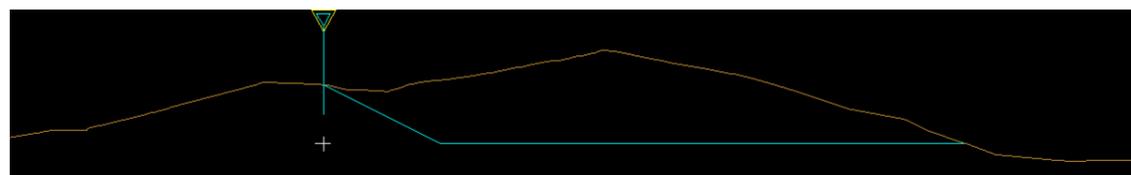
Representación transversal de la excavación del estribo Norte. Fuente: Elaboración propia.
